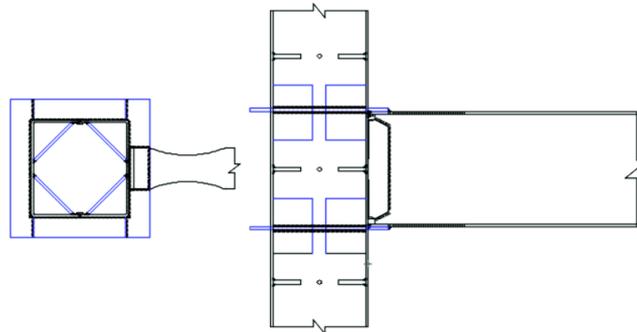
1: Conexión viga columna con anillo de placas de refuerzo [24]
